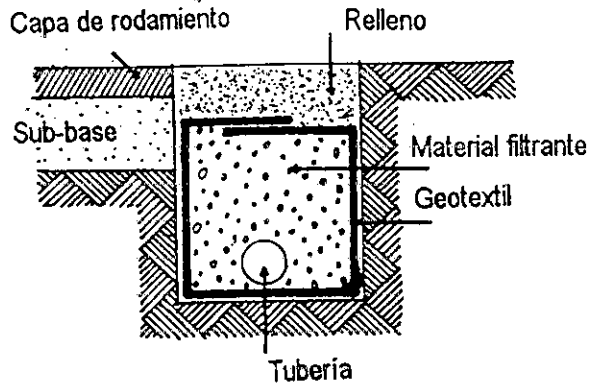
Drenaje adyacente al pavimento (vista en elevación)
